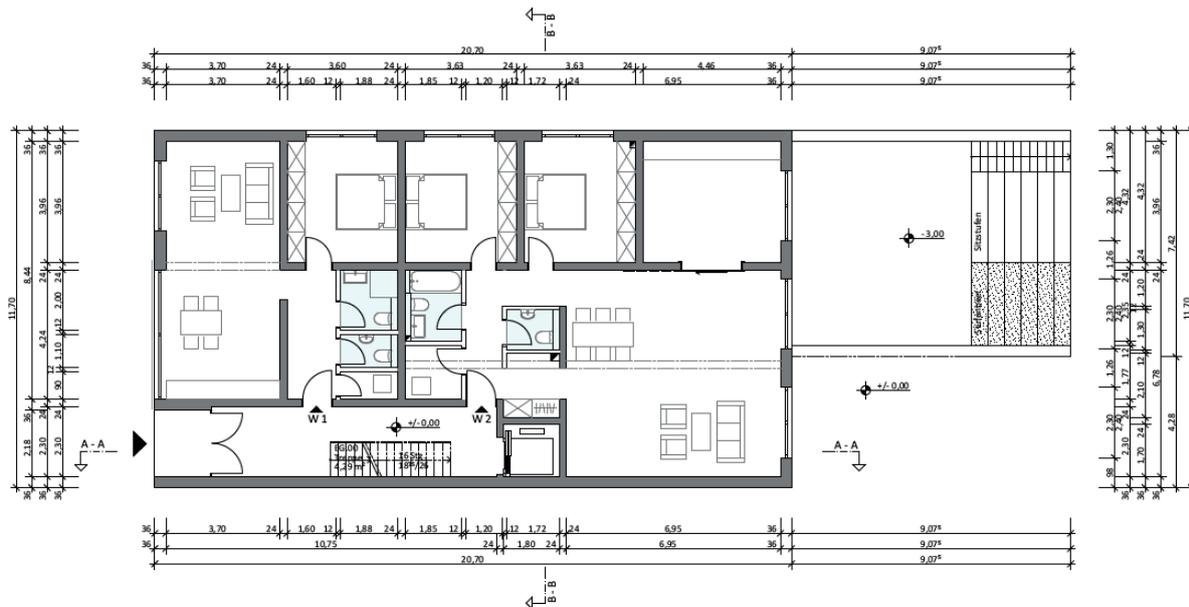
Der erste Fünfer – Grundriss Erdgeschoss (ohne Maßstab)
